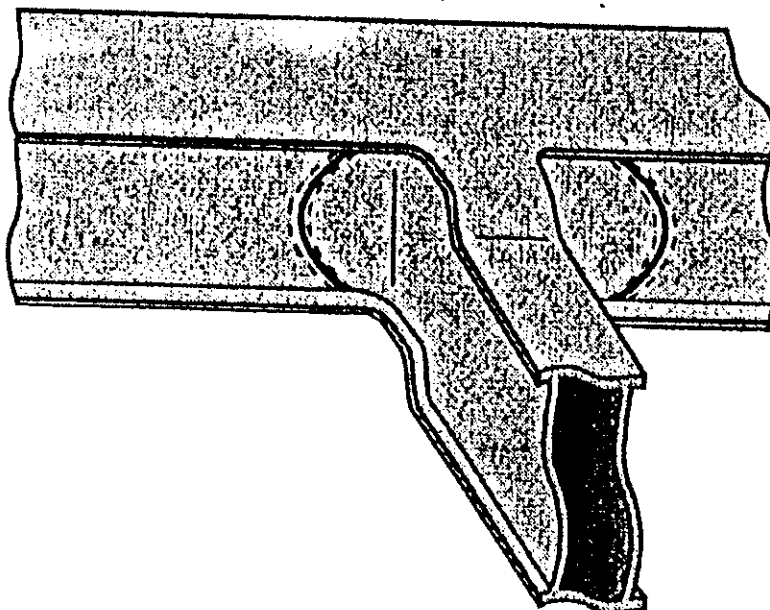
Контроль вертикальных сварных швов
